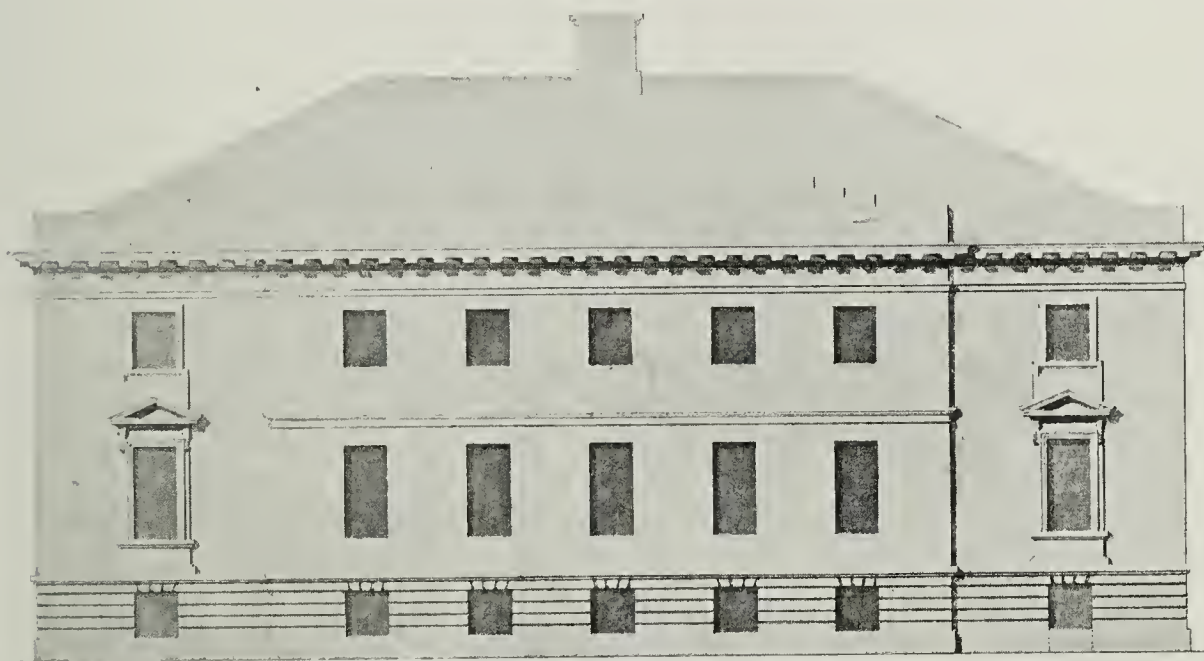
Første Udkast til Banken bag Børsen. Sidefaçade.
